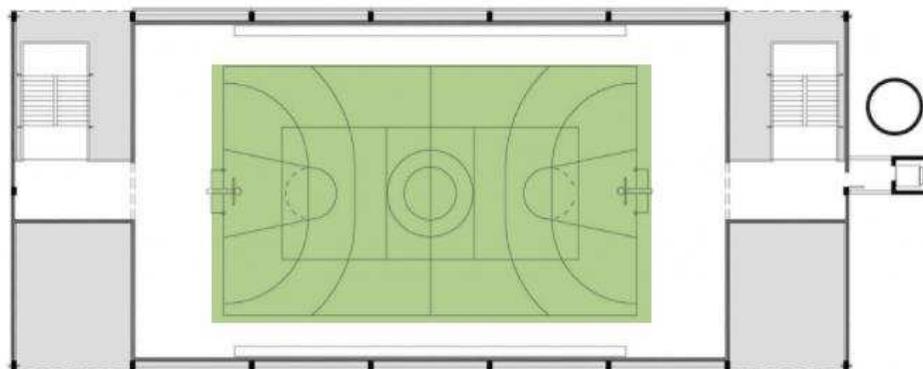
Escola em Campinas – planta do 2º pav. Fonte: Una Arquitetos, editado pela autora.
